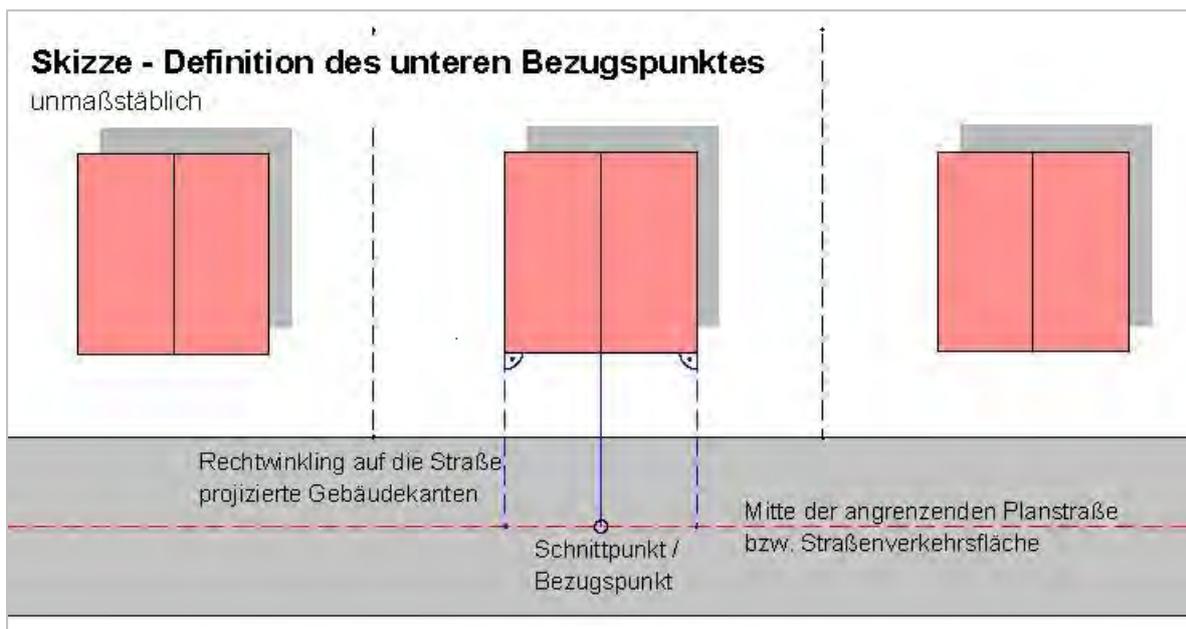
Schematische Darstellung zur Definition der unteren Bezugshöhe für ein Baugrundstück
